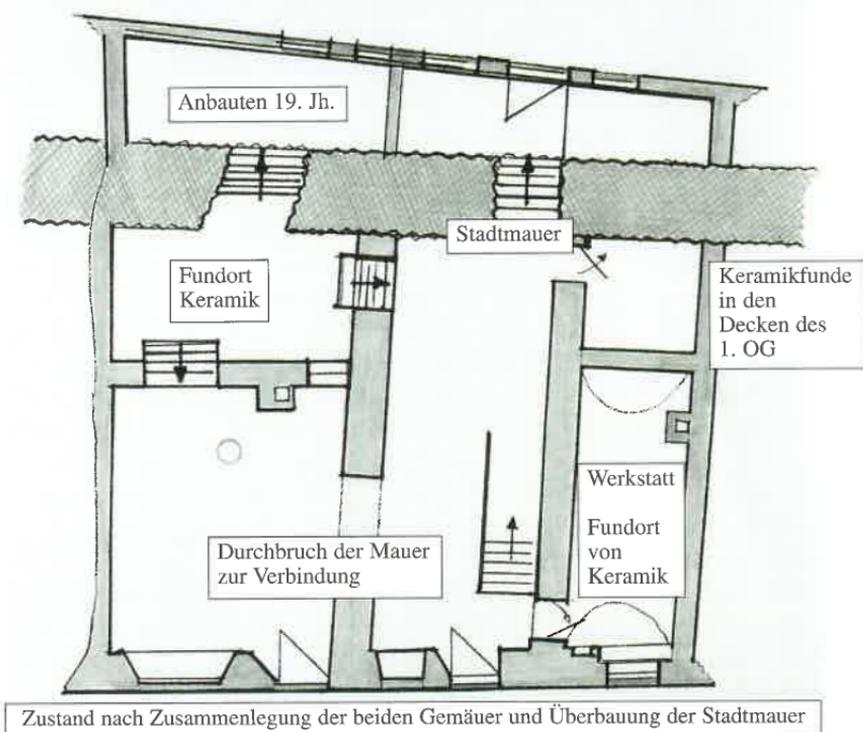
Abb. C: Grundriss des Hafnerhauses nach der Erweiterung
